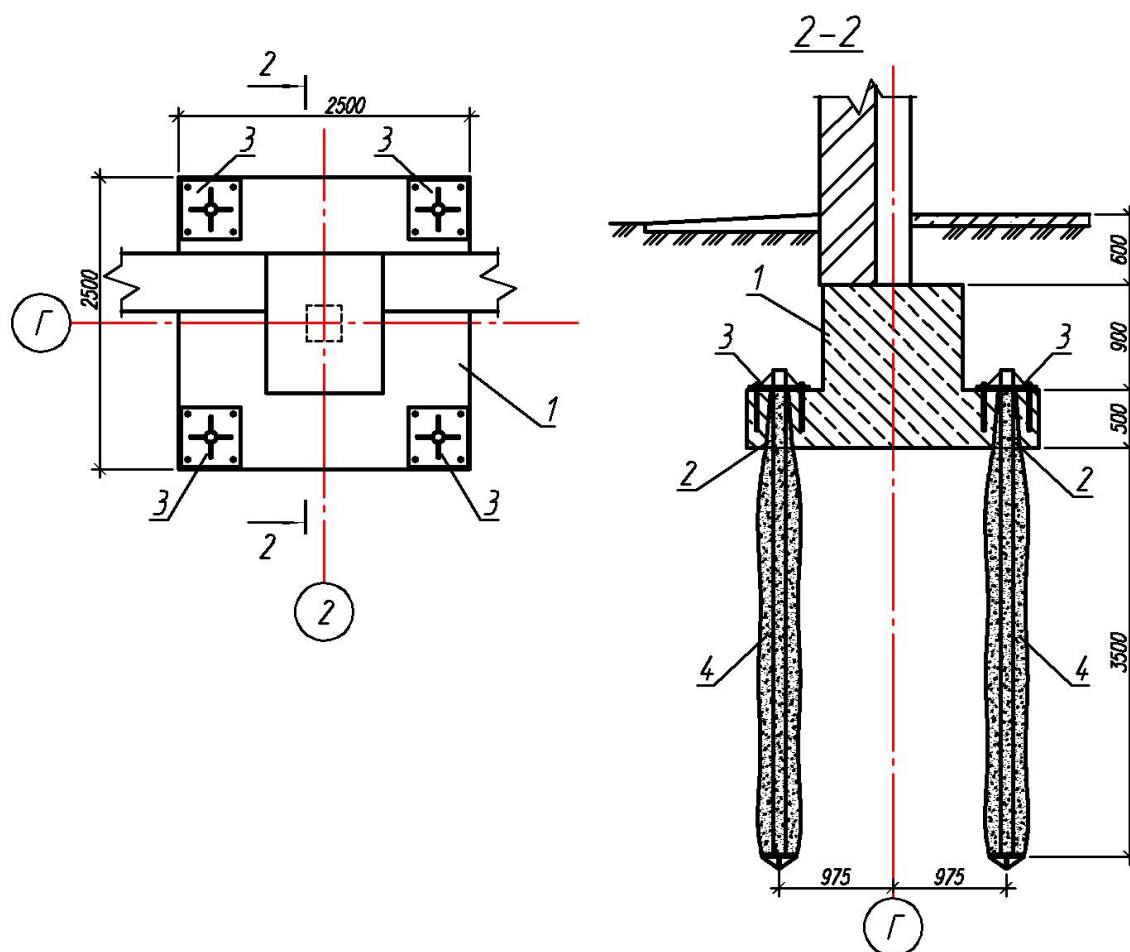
Технические решения по усилению отдельных фундаментов обследуемого здания клиники №5 при помощи инъекционных свай:
